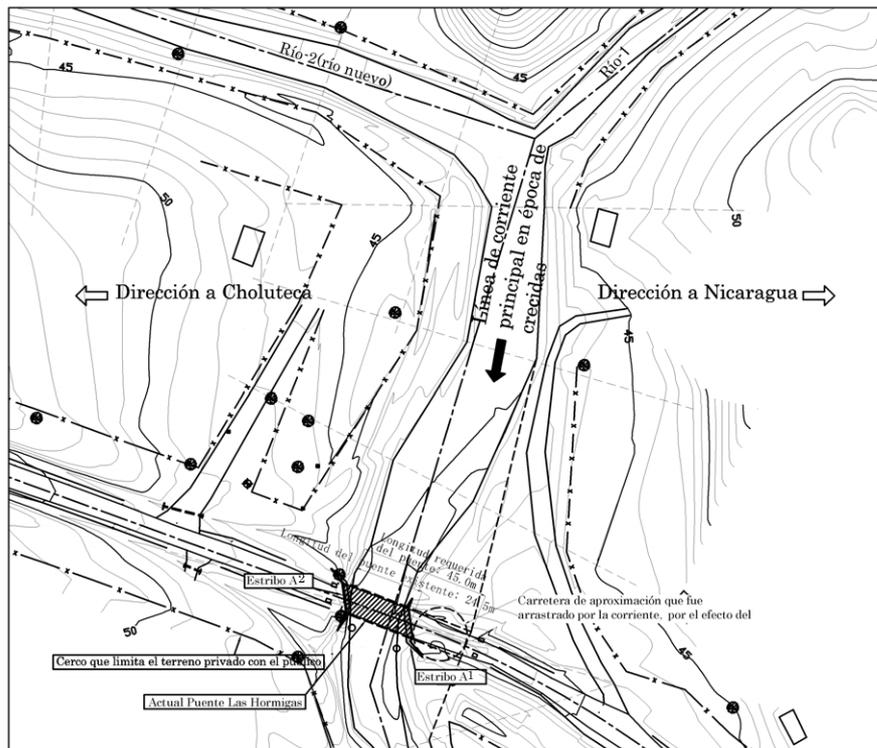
Estado Actual de la Zona de Ubicación del Puente Las Hormigas
